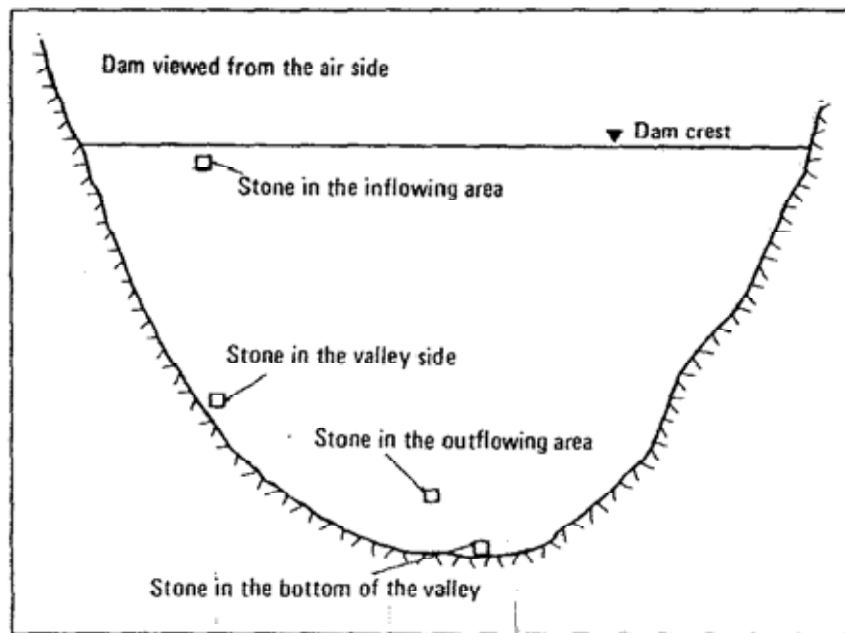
Zonas críticas del espaldón en el sobrevertido. Alzado. (Fuente: Skoglund y Solvik 1995)
